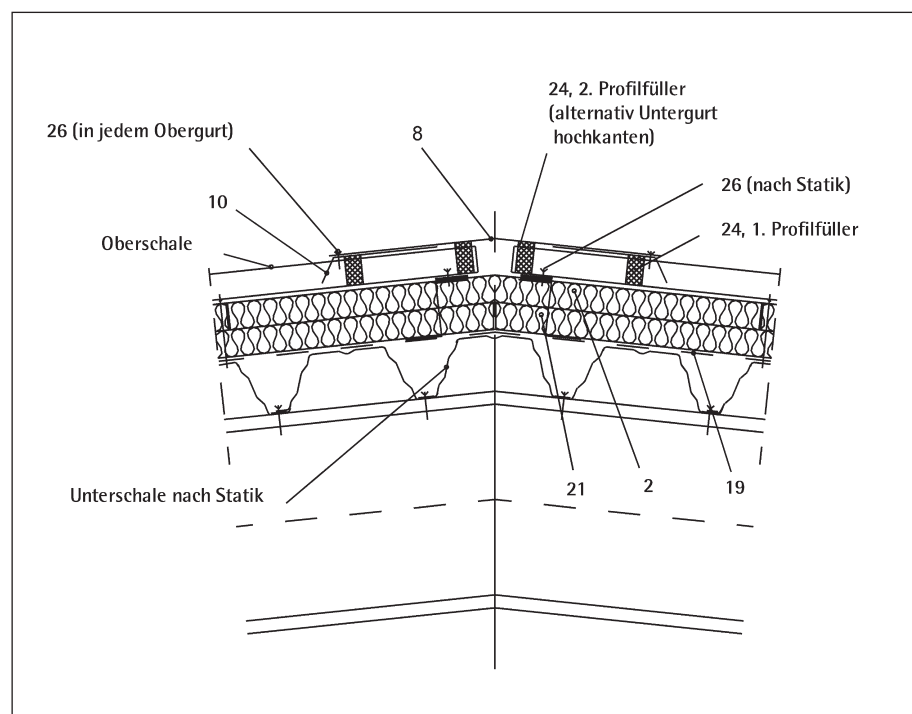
Zweischalige Dachkonstruktion: Firstausbildung
